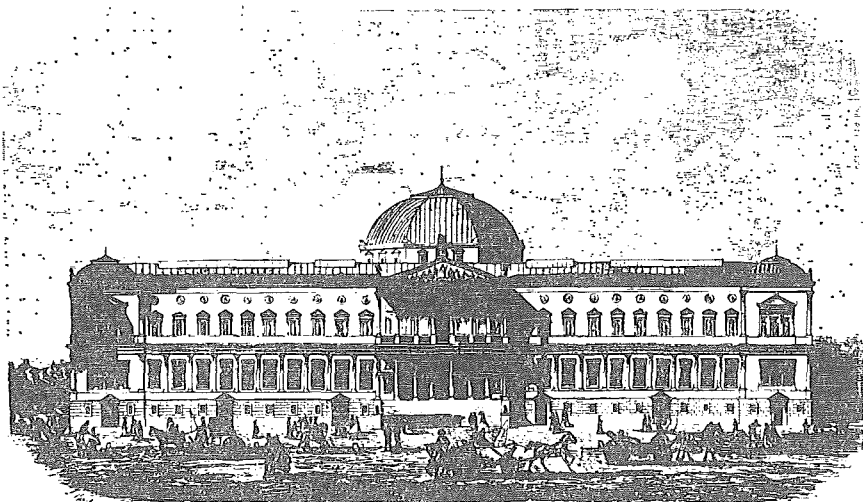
F. Jareño y Alarcón: Proyecto para la fachada de la Biblioteca Nacional.
